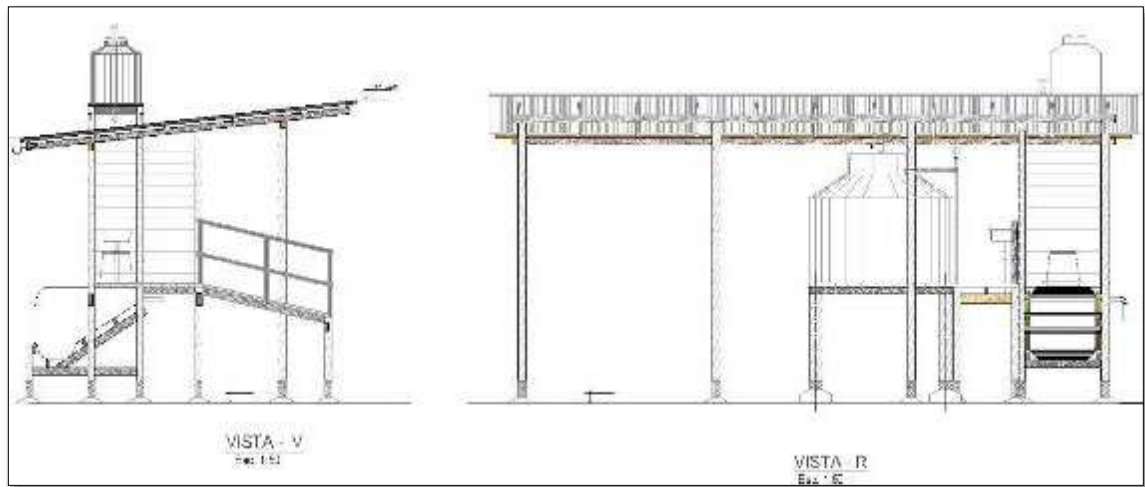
Módulo de captación de aguas pluviales con sistema constructivo en madera
